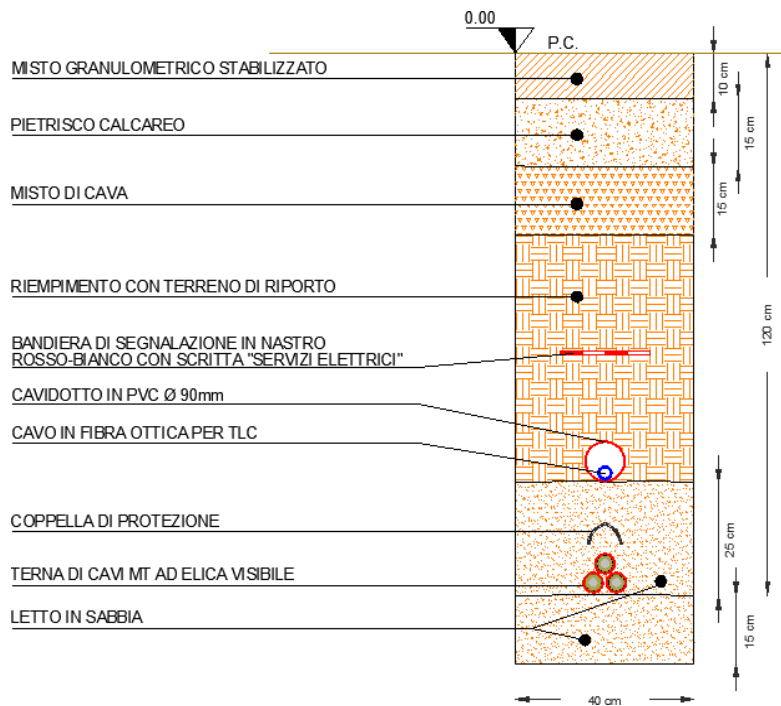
Sezione tipo di scavo per la posa del cavidotto su strada esistente. I cavi elettrici, rispetto ai piani finiti di strade o piazzali o alla quota del piano di campagna, saranno posati negli scavi alla profondità di circa 1,00-1,20m.
